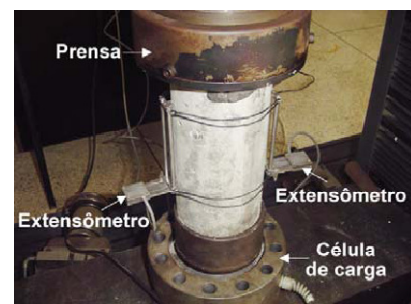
Execução do ensaio do módulo de elasticidade: Equipamento de leitura digital e instrumentação do corpo-de-prova.
